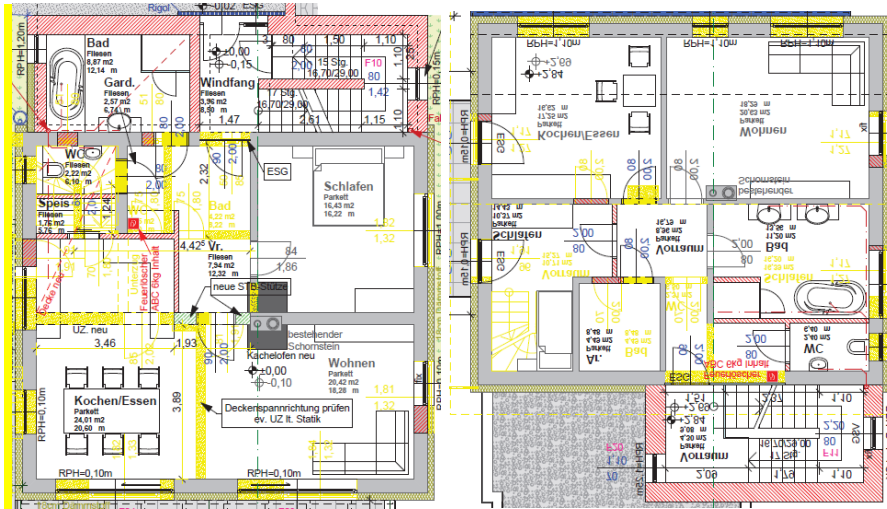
Grundriss EG (links) und Grundriss OG (rechts) des Solarhauses Inschlag (Quelle: Einreichplan)
